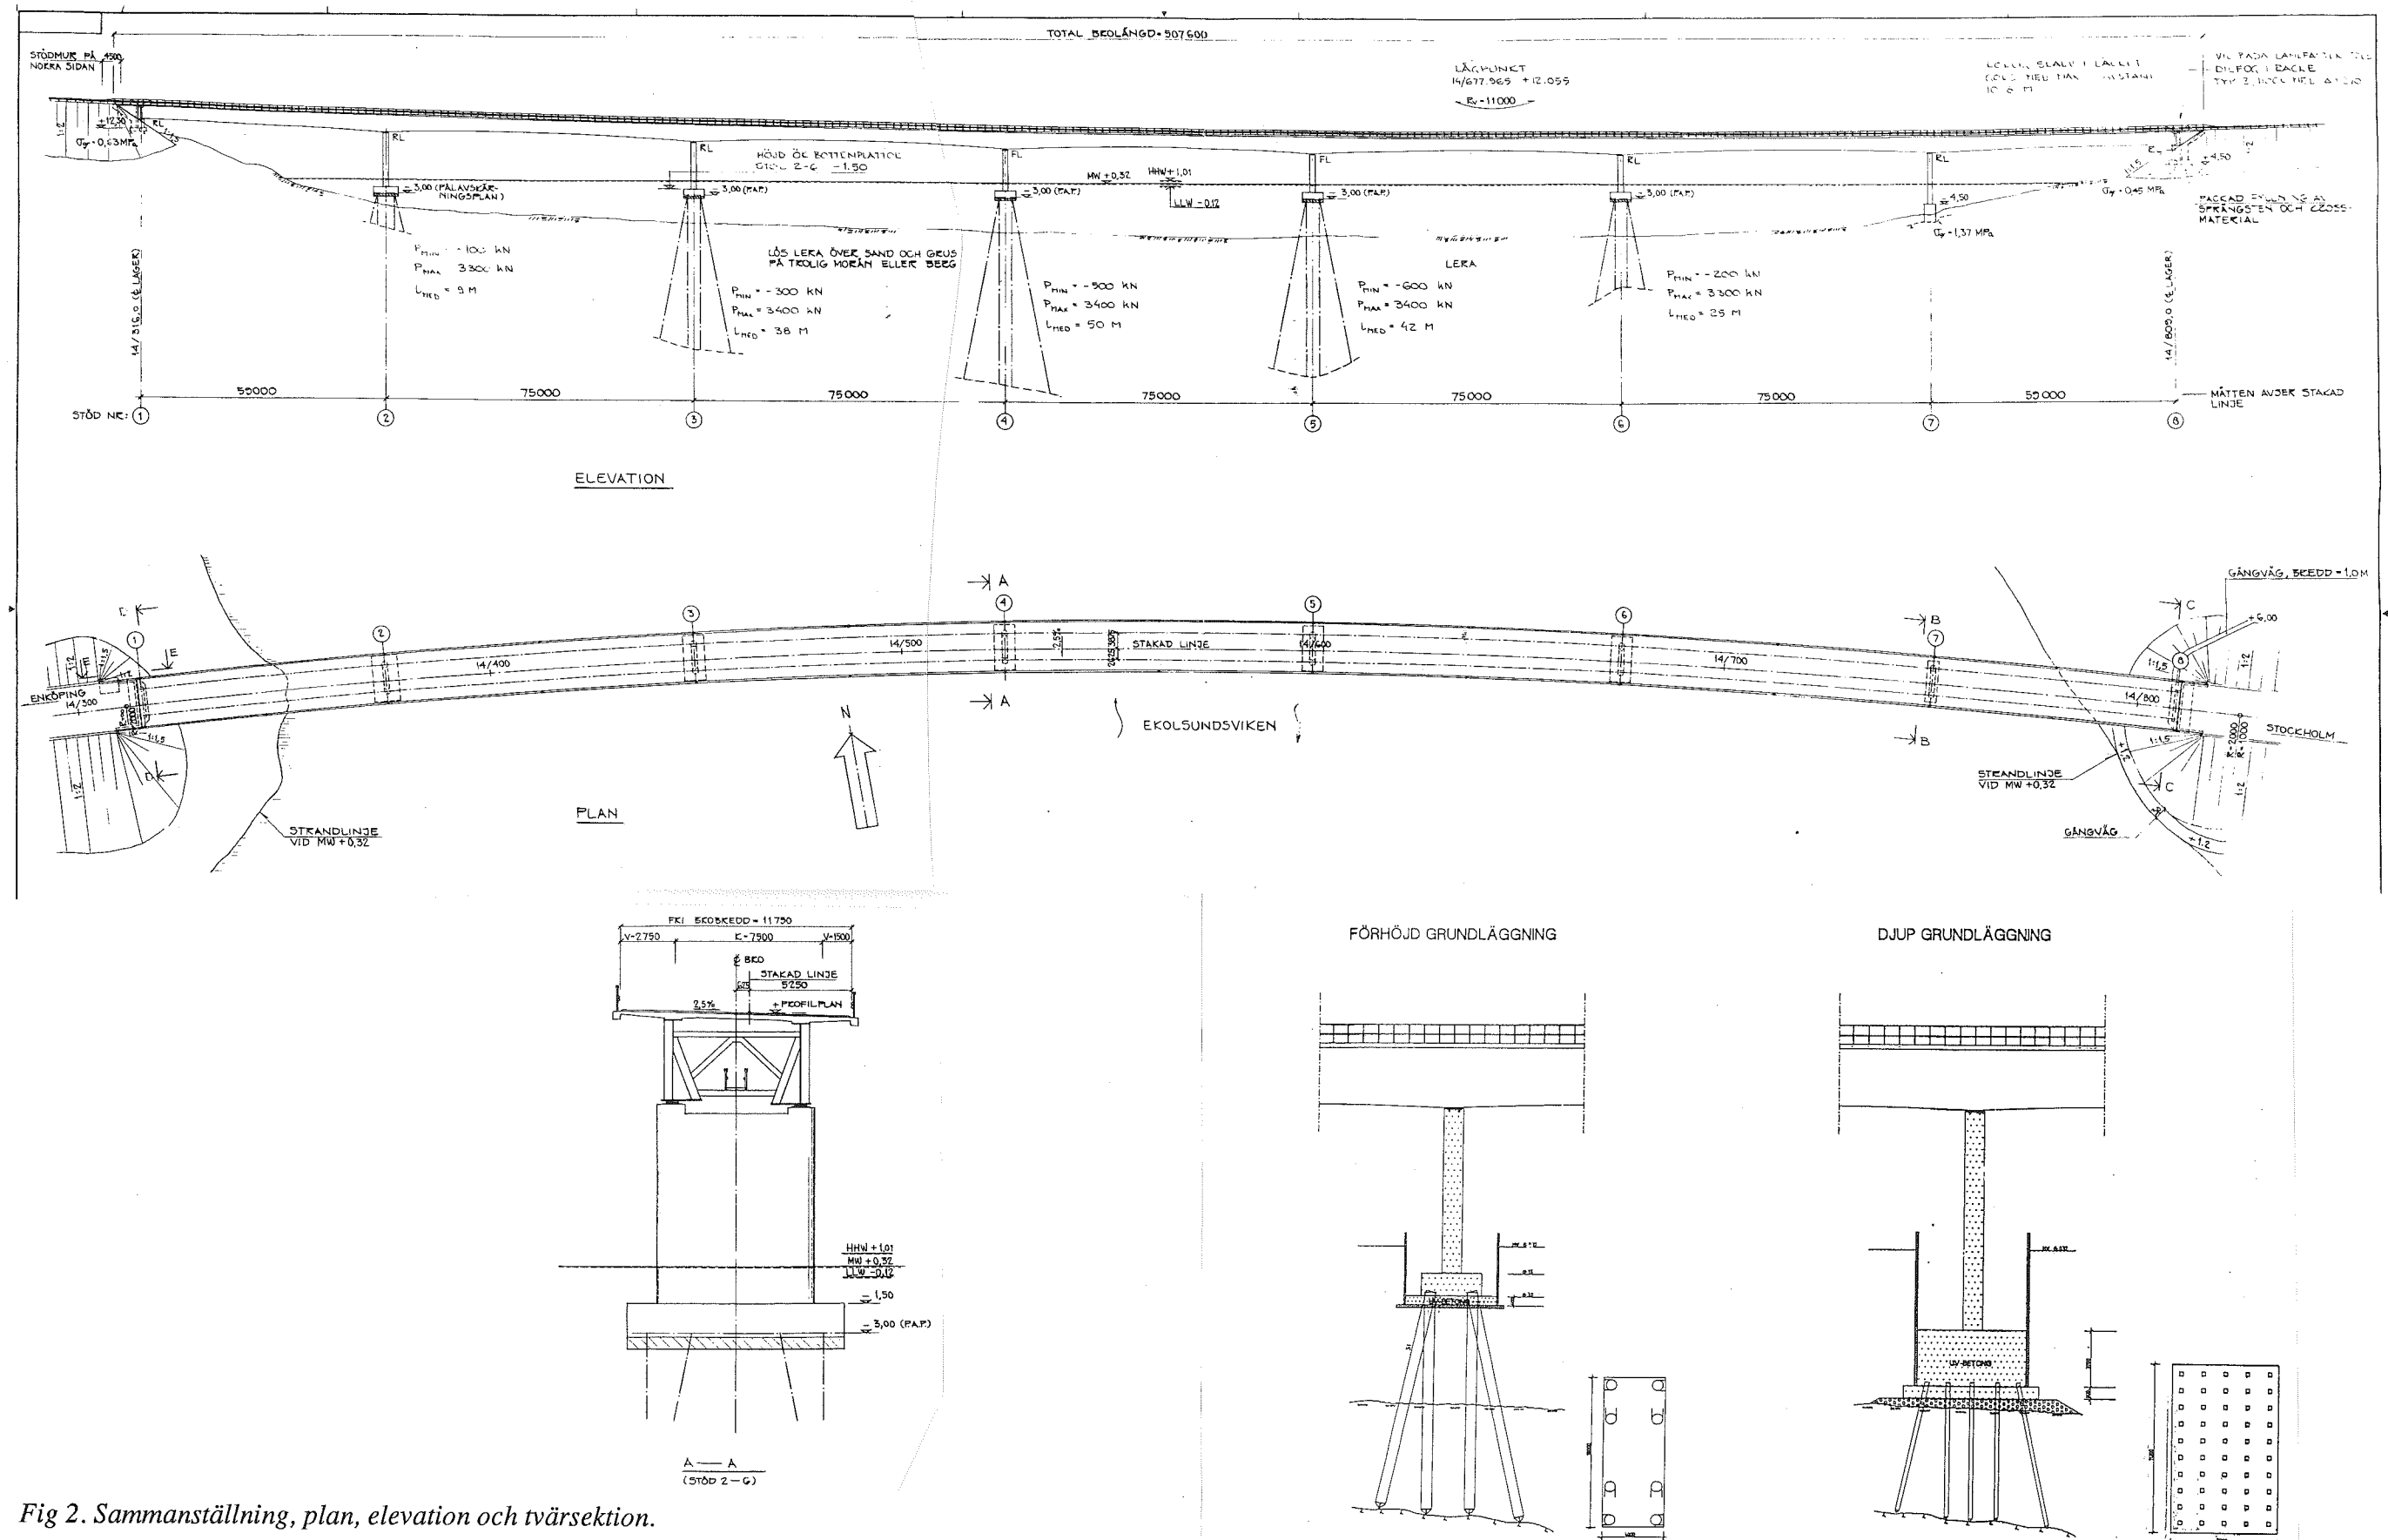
Sammanställning, plan, elevation och tvärsektion.
